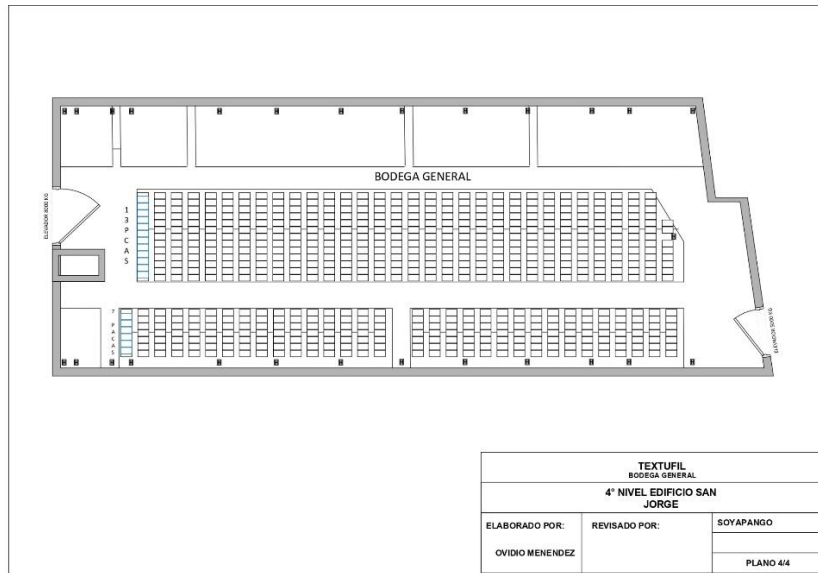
Distribución en Planta Nivel 4 edificio San Jorge
